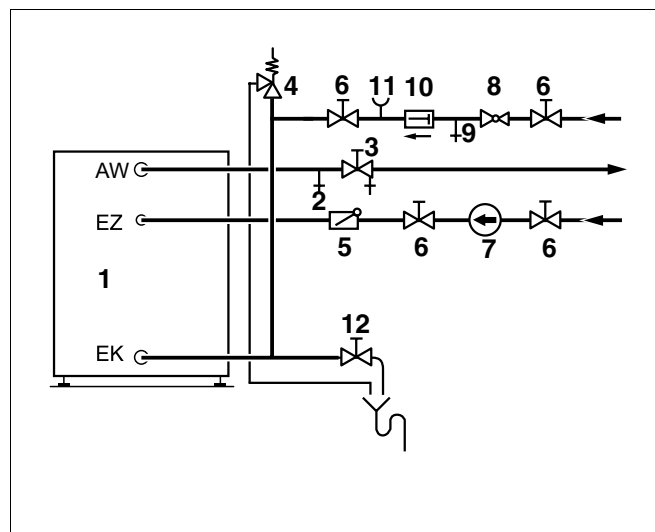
Installazione secondo DIN 1988 (illustrazione schematica)
